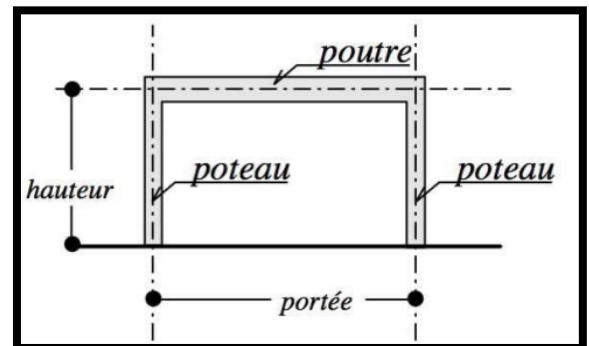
Un portique est une structure composée de deux poteaux et une poutre qui dégage un espace entre ces trois éléments et le sol Source :
